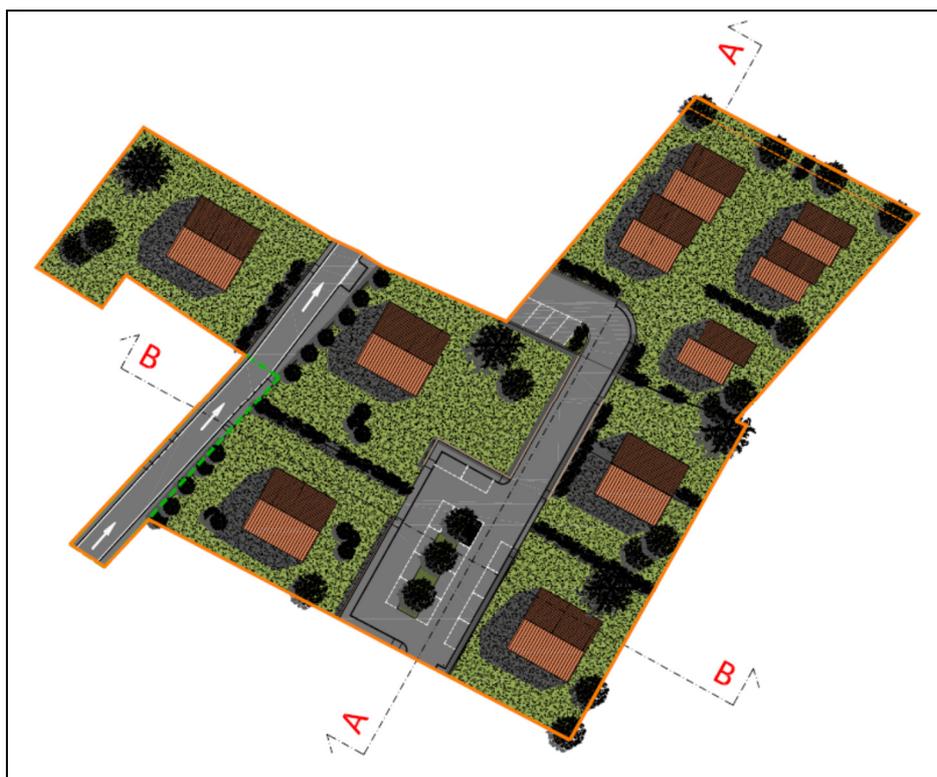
IMPIANTO PLANIVOLUMETRICO
